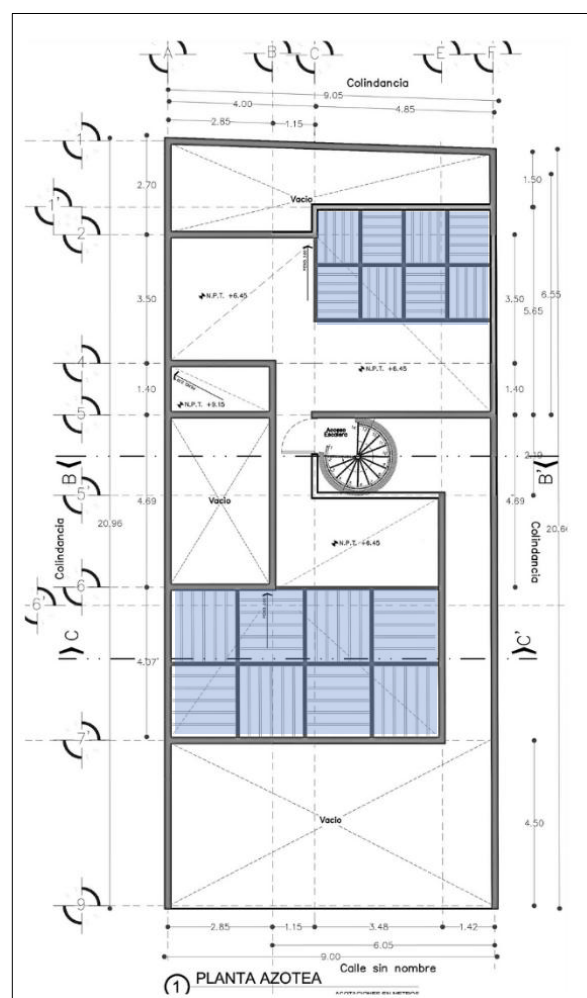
Plano arquitectónico Planta Azotea modificaciones. Elaboración propia. (YPHC 2025)
